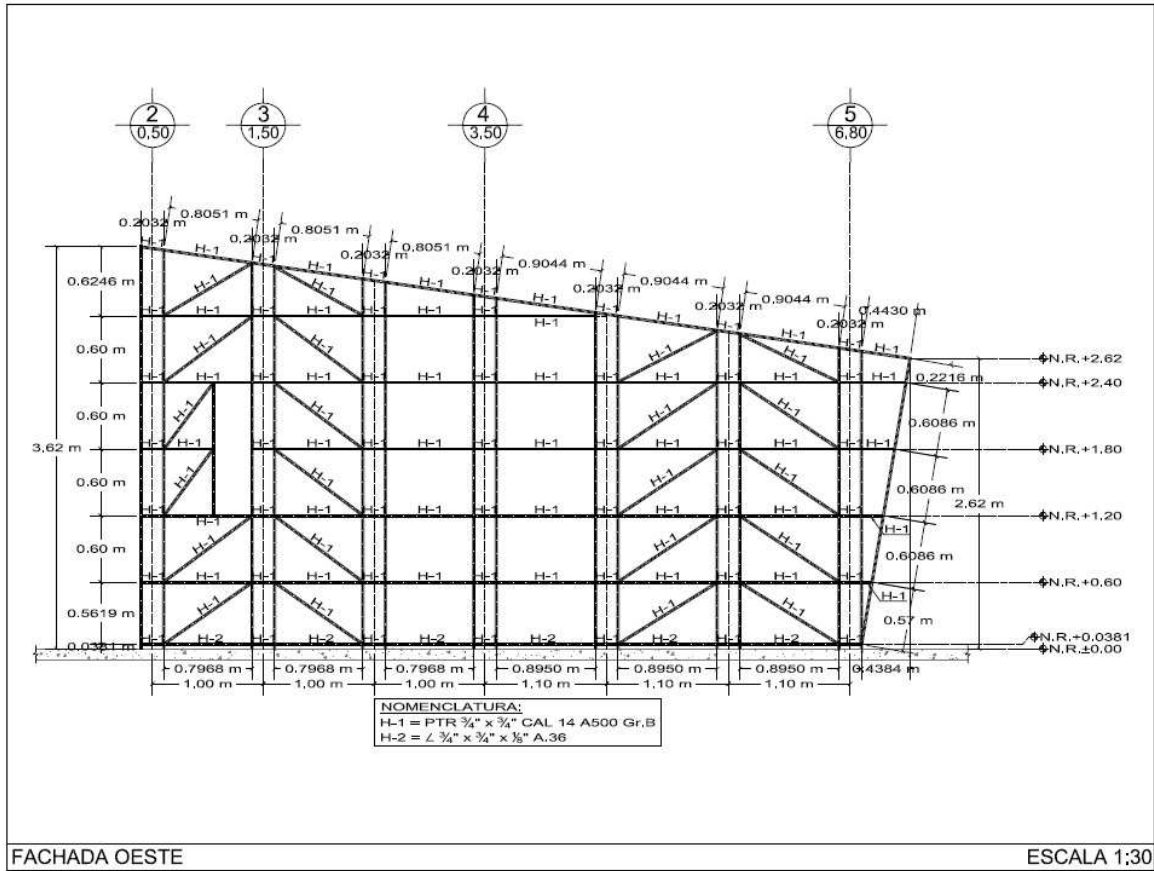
Fachada Oeste de plano estructural de propuesta a base de panel doble.
